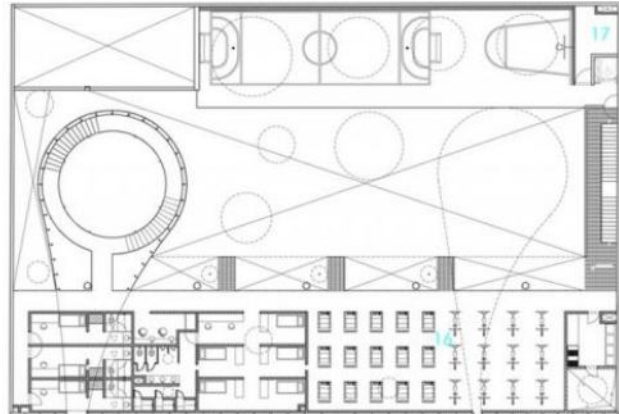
Planta Cuarto Nivel. Estación de Bomberos Ave Fénix. Fuente [www.arqdaily.com](http://www.arqdaily.com)
